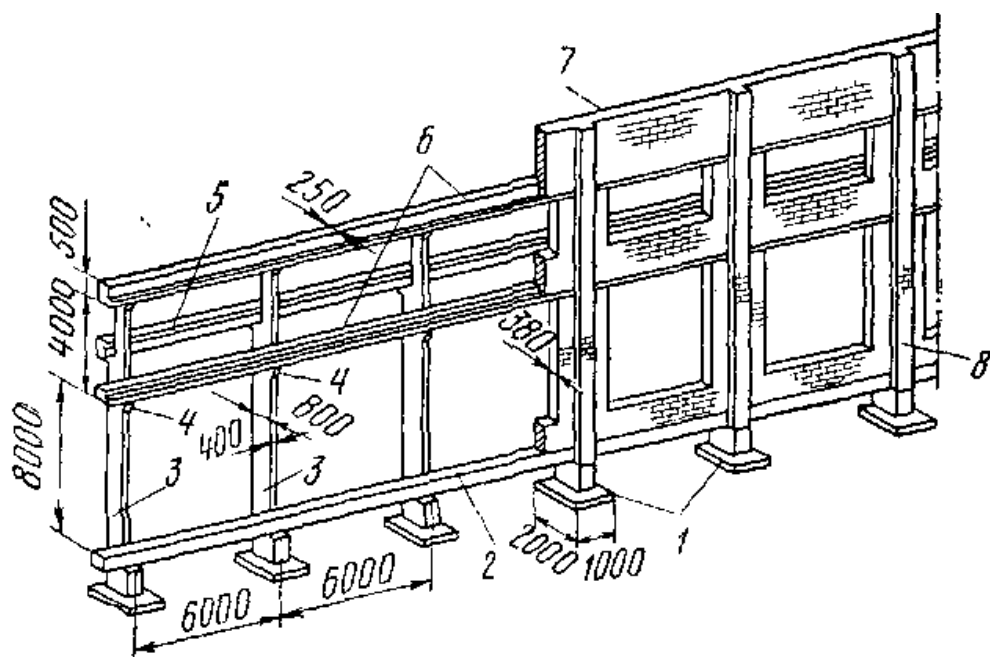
Самонесущая кирпичная стена большепролетного здания с железобетонным каркасом:
